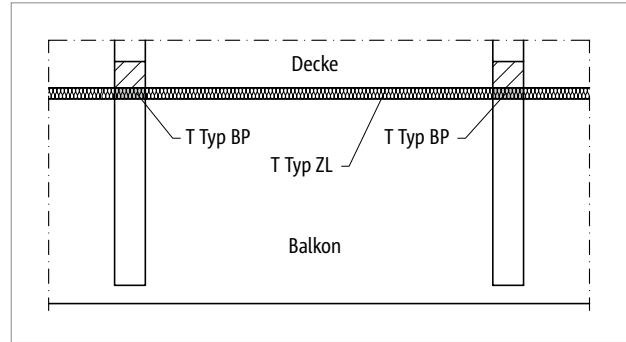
Schöck Isokorb® T Typ BP: Balkonkonstruktion mit frei auskragenden Unterzügen
